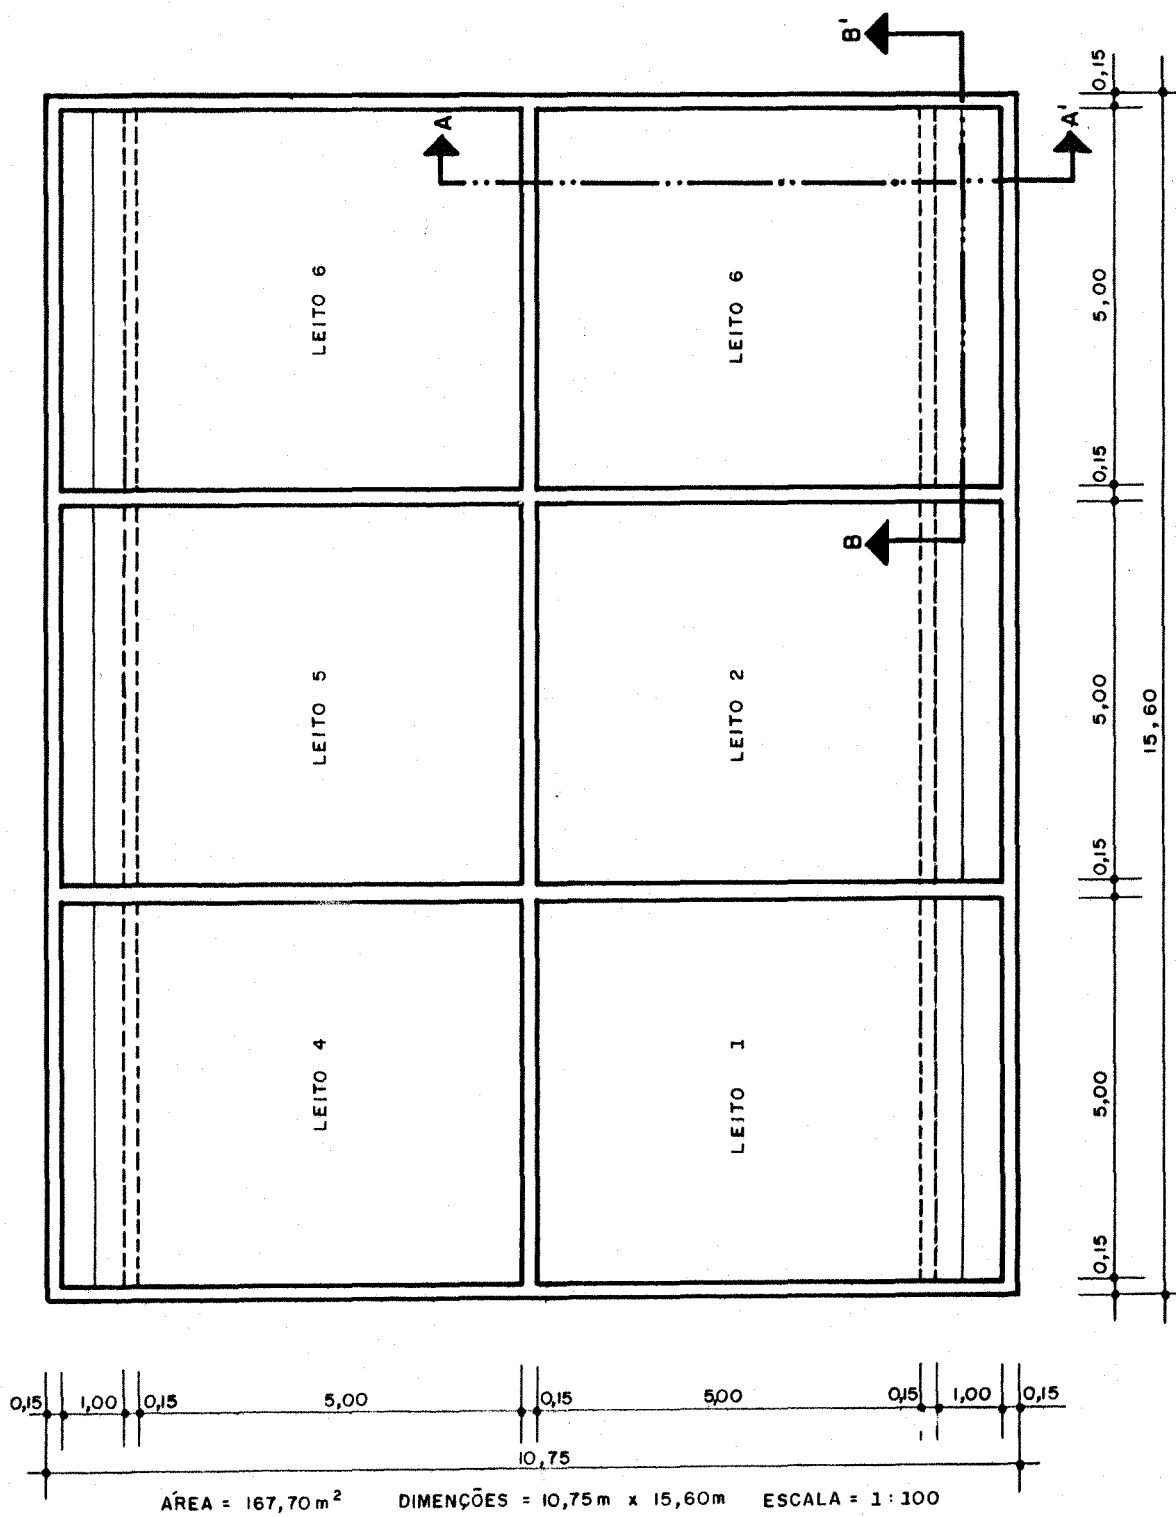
Planta baixa dos leitos de lixiviação (teste em escala piloto).
